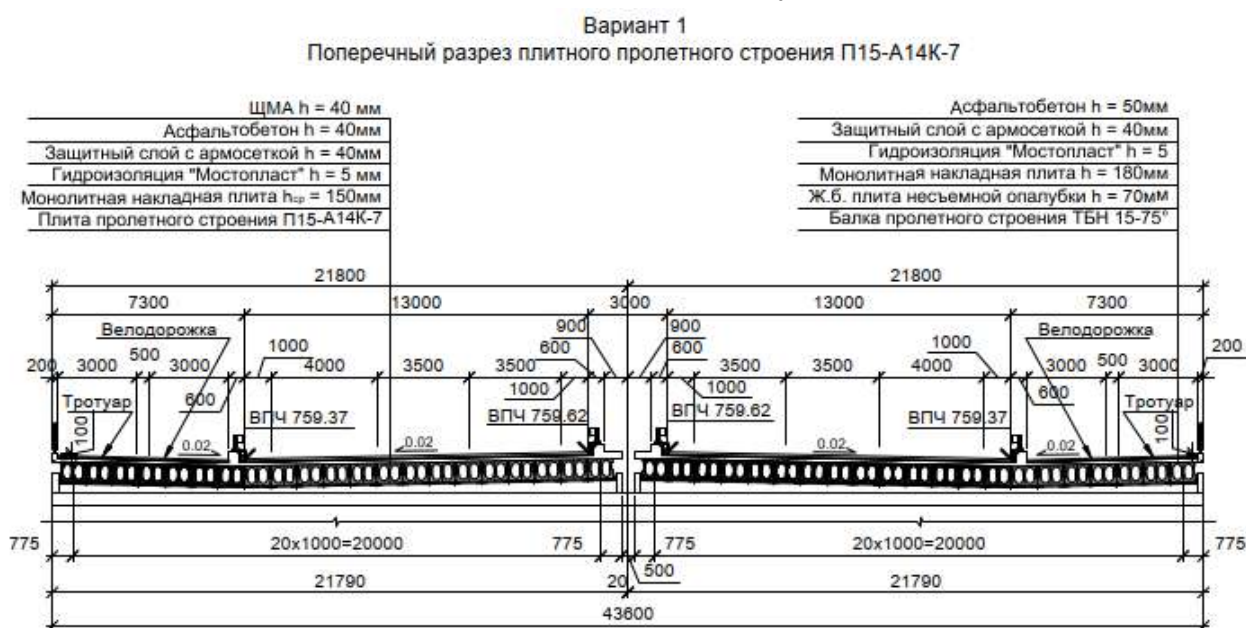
Поперечный разрез пролетного строения П15-А14К-7. Вариант 1
